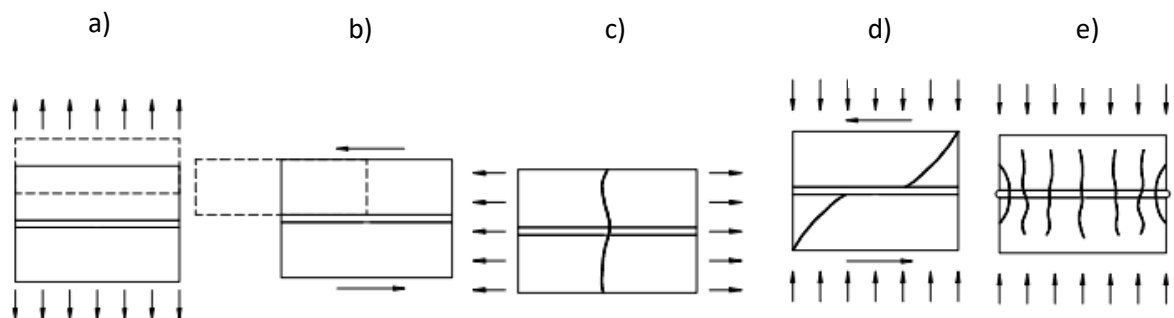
Mecanismos de ruptura: (a) Fissuras nas juntas; (b) Escorregamento; (c) Fissuração das unidades; (d) Fissura diagonal; (e) Fendilhamento (Cheema)
